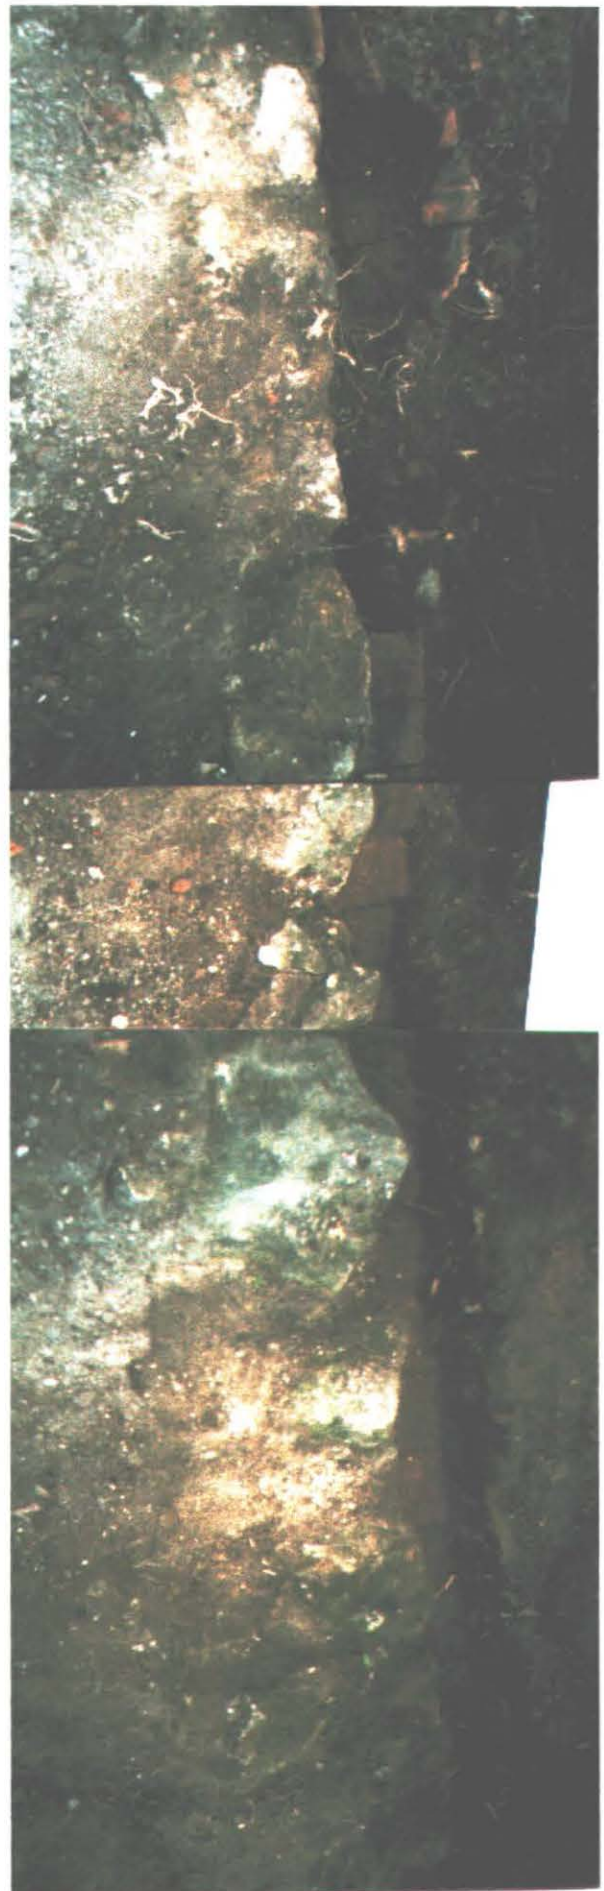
Revestimento da canaleta com lajotas (cerâmicas).
